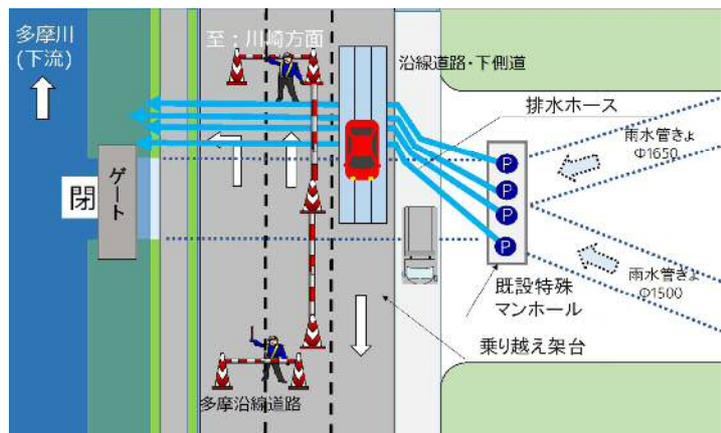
1 3 二子排水樋管 排水ポンプ投入用マンホール詳細図
